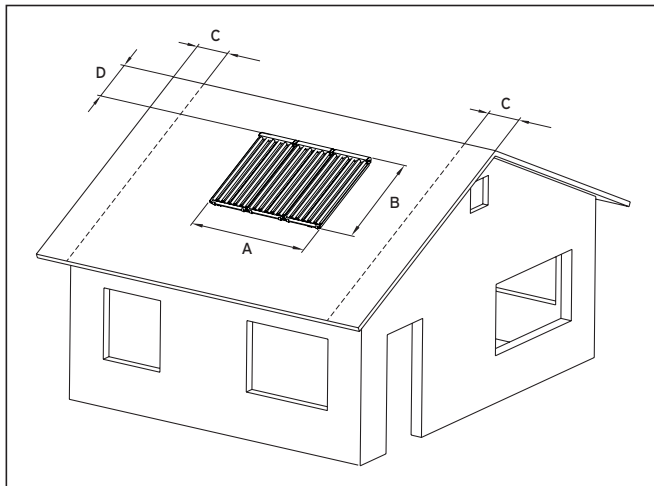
Wichtige Maße bei Schrägdachmontage
